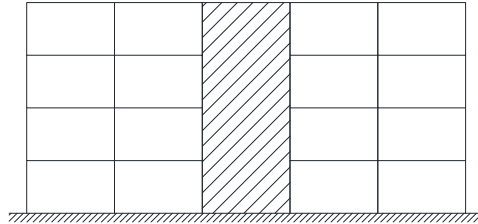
Struktura me mure betoni dhe konstruksion metalik
